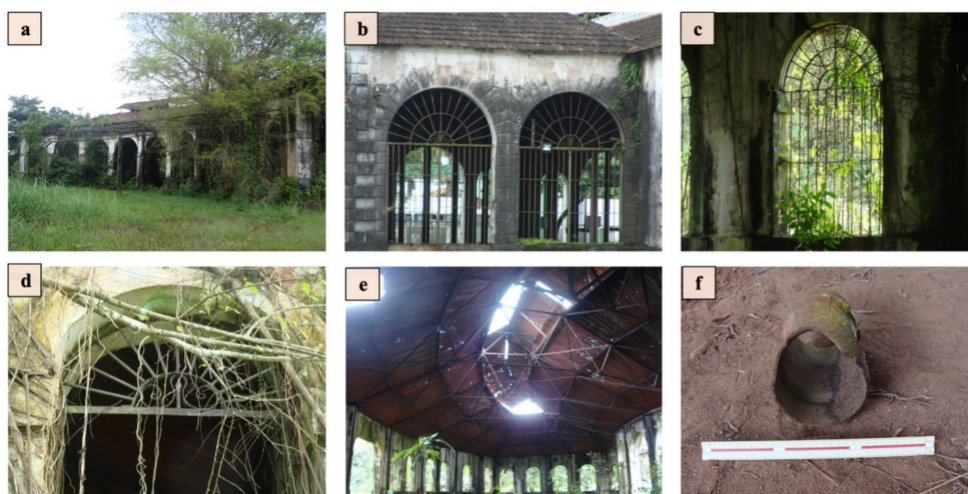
Armazéns das antigas oficinas da EFB em Marituba. (a,b,c) vista parcial da estrutura; (d) vista interior da estrutura, vigas, tesouras e colunas em metal; (e) detalhe de tubulação em metal
